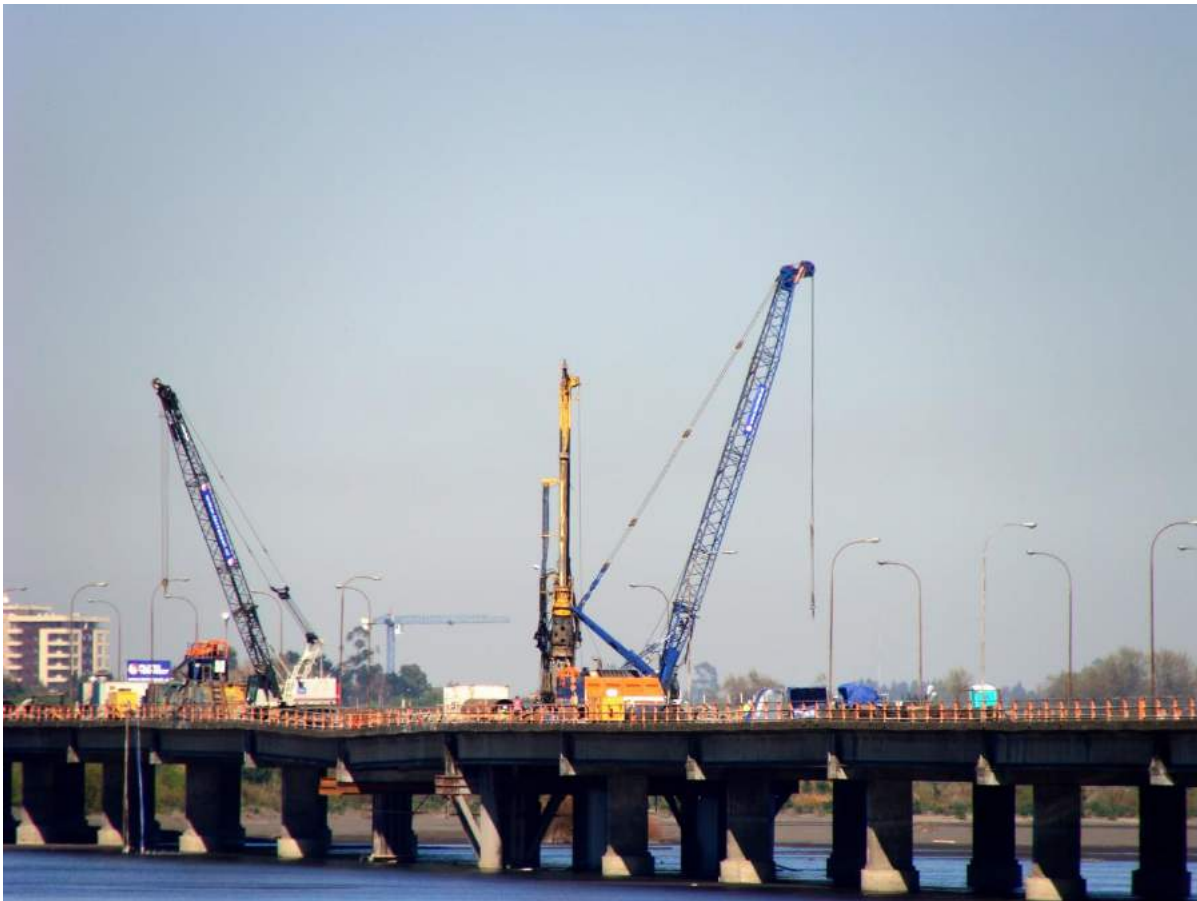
Equipos de pilotaje reforzando las fundaciones del Puente Juan Pablo II
